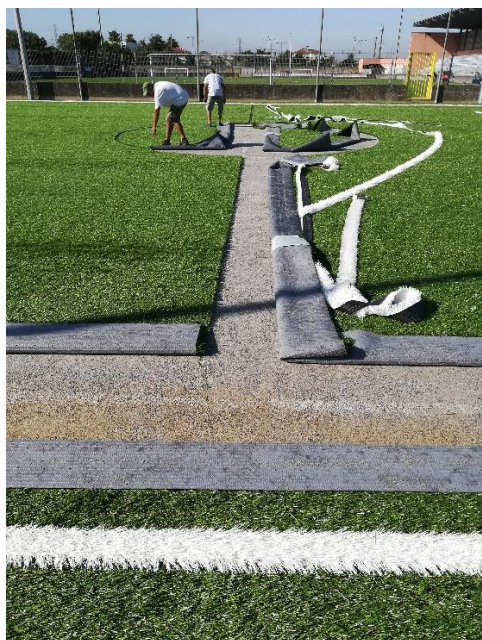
Recorte do relvado sintético para colagem das marcações de jogo.
